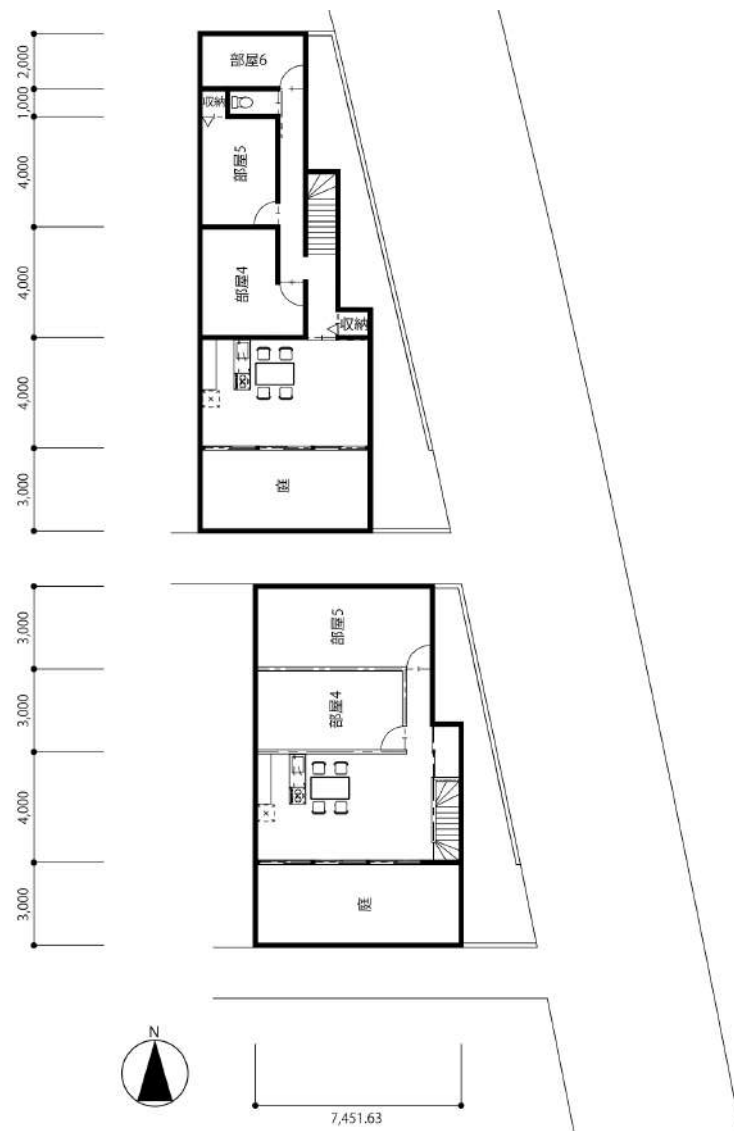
区画道路（車道）を生かした住居 2 階平面図
